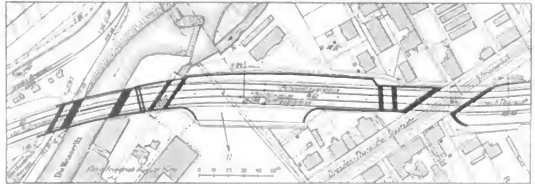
Lageplan nach vollendetem viergleisigem Ausbau.
